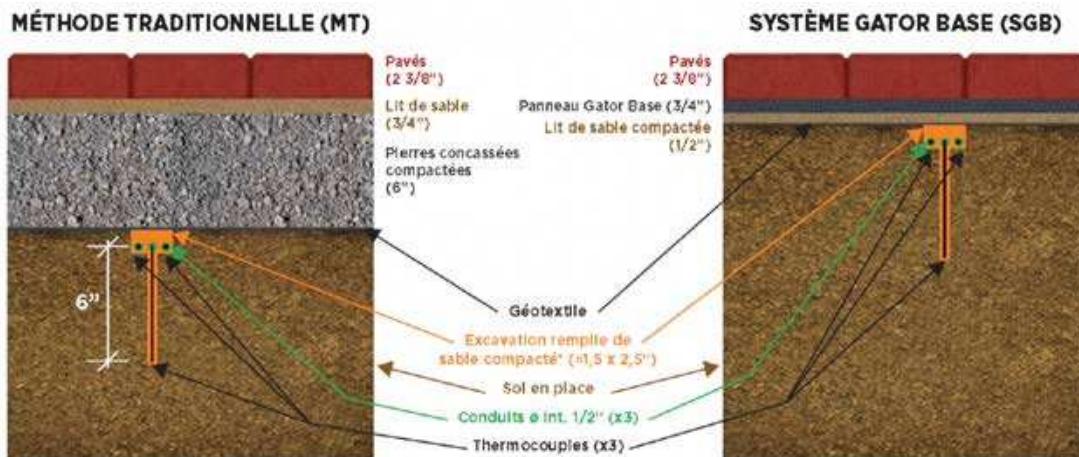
Cas type du positionnement des thermocouples et conduits sous les sections de pavés unis /dalles (vue de profil)
